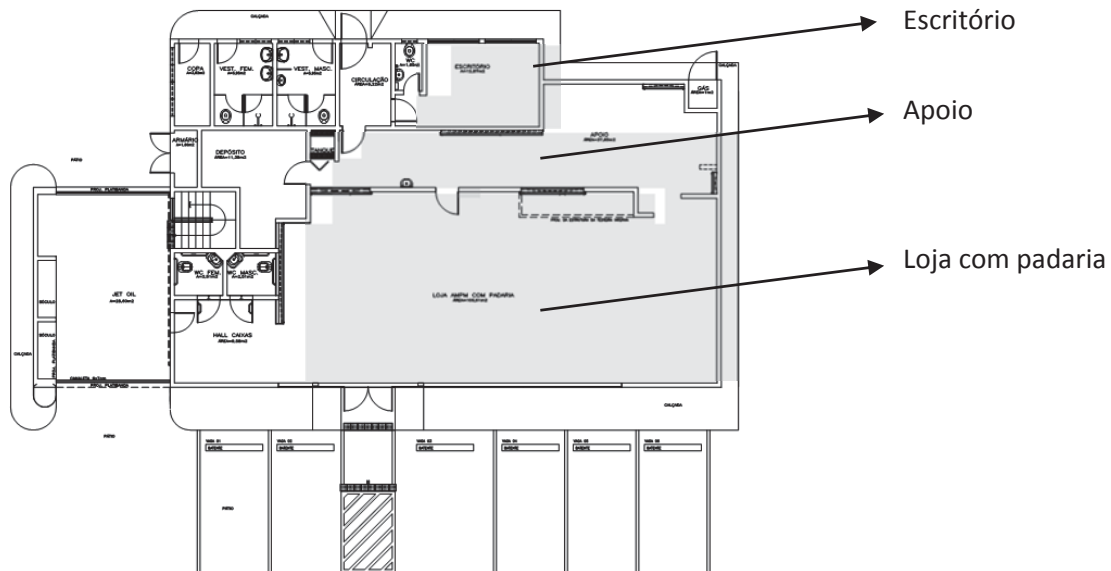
Planta baixa referencial da edificação do posto de abastecimento.
